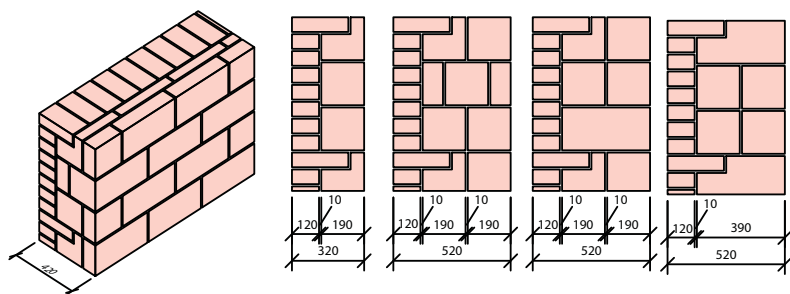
Кладка из бетонных камней (блоков) с четвертью с облицовкой кирпичом [4], 1951 г.
